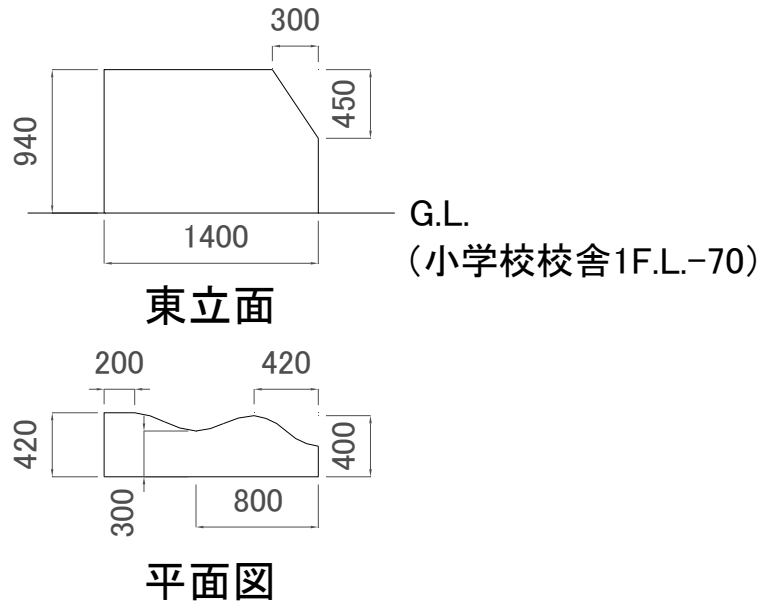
石碑の立面図・平面図 (単位: mm)
